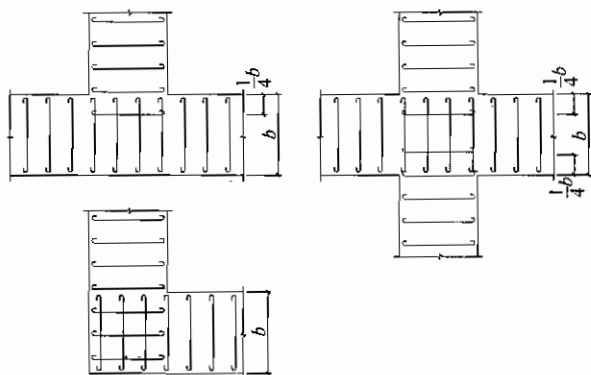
墙下条形基础纵横交叉处底板受力钢筋布置
